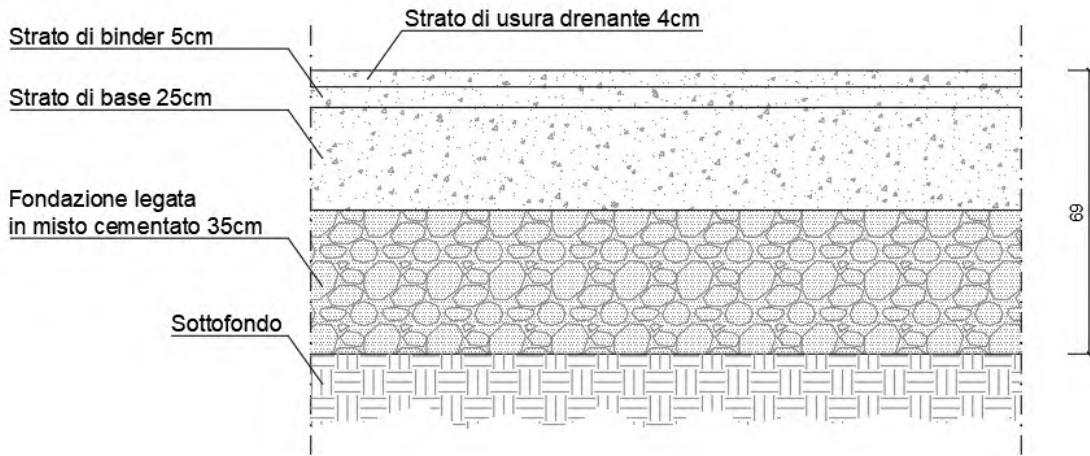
Pacchetto di ripristino pavimentazione autostrada e tangenziale TIPO P4A
